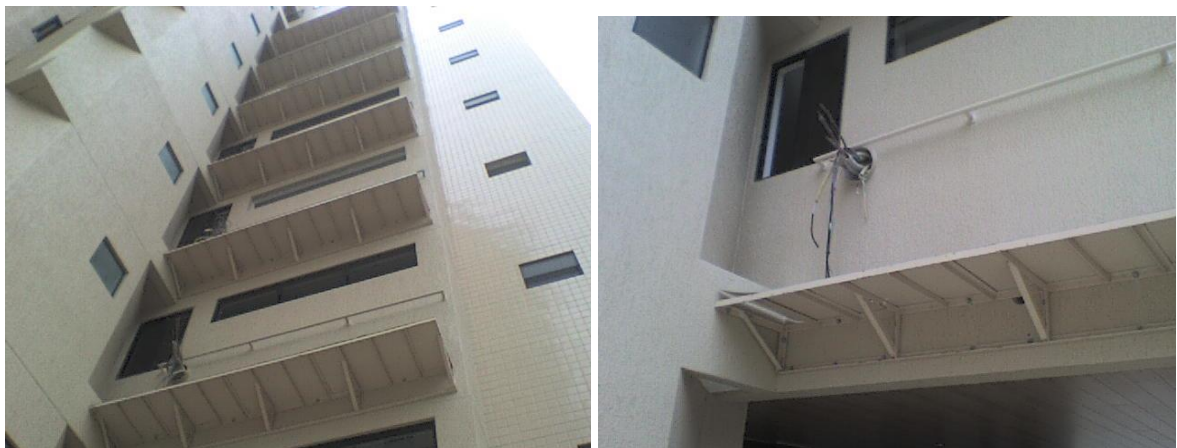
Edifício Palazzo Ducale, bairro de Ponta Verde, Maceió-AL.
